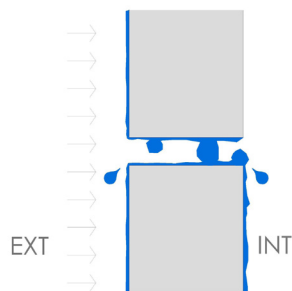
Imagen de junta horizontal lisa de 7,5 mm . Sección.
